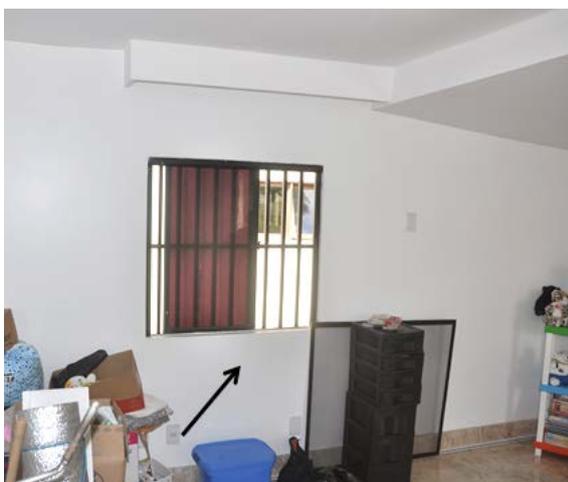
2ª vistoria. Fissura abaixo da janela no quarto de casal.
